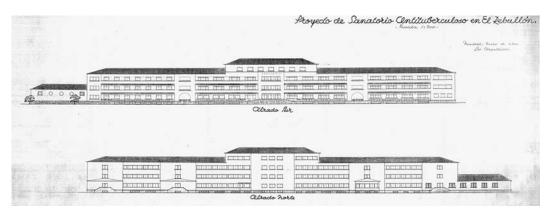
Sanatorio de El Rebullón, fachadas. Fondo Font de Bedoya, Archv^o. H. P. Palencia
